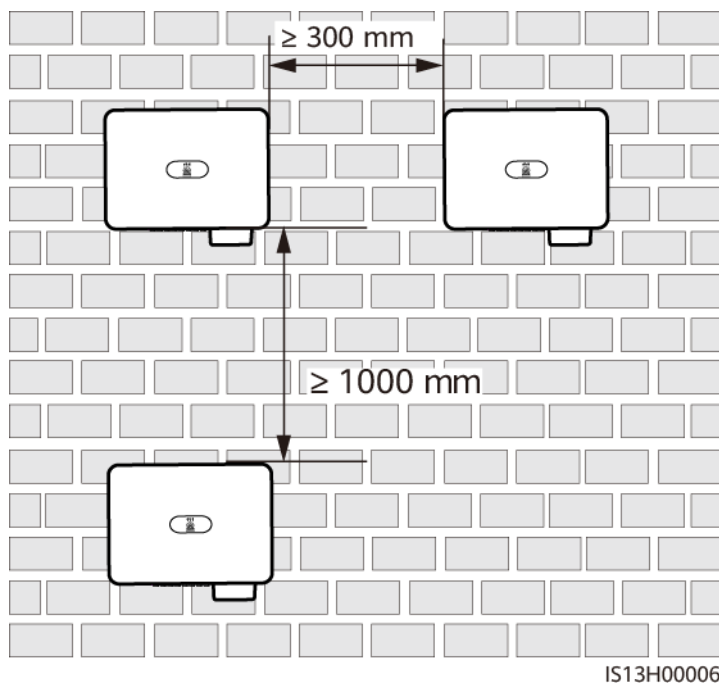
Triangelinstallation i två lager (rekommenderad)
